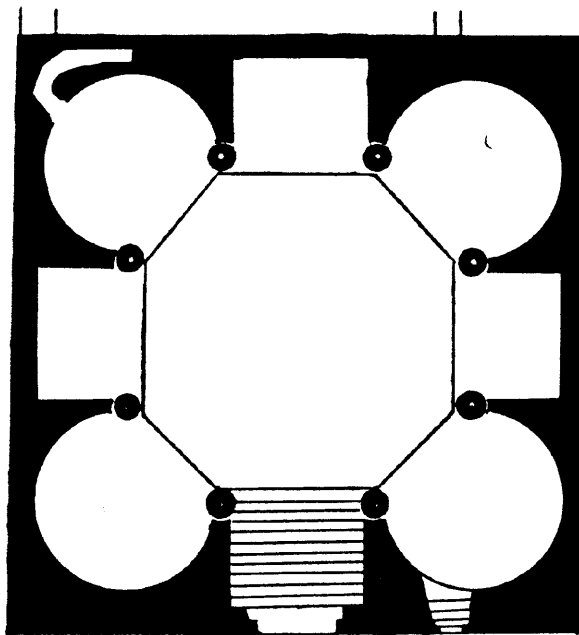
Fig. I — PIANTA DEL BATTISTERO DI BRESCIA
